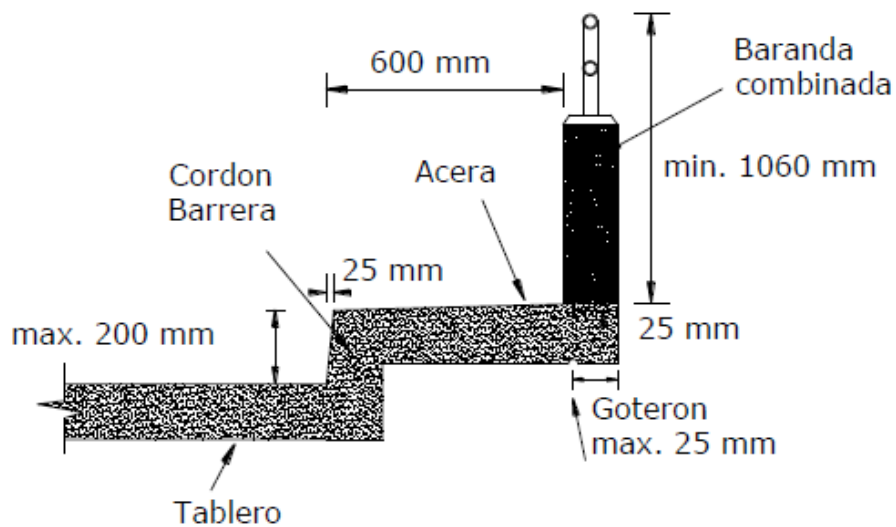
Componentes de la superestructura de un puente Viga – Losa.
